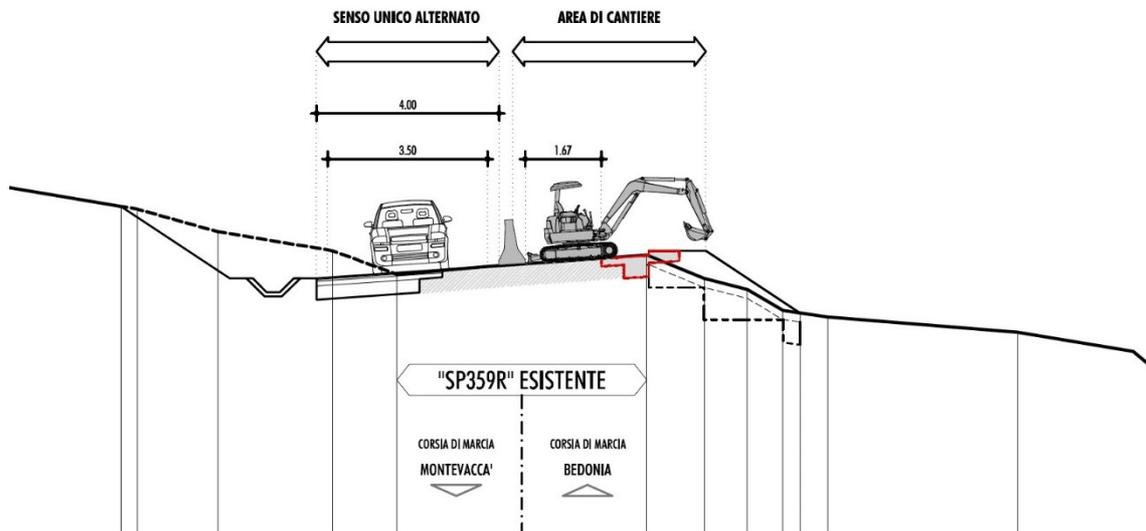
TRATTO 2, FASE 3: TRAFFICO SU CORSIA DI MONTE (ESTRATTO DALL'ELAB. PD.04.04)
